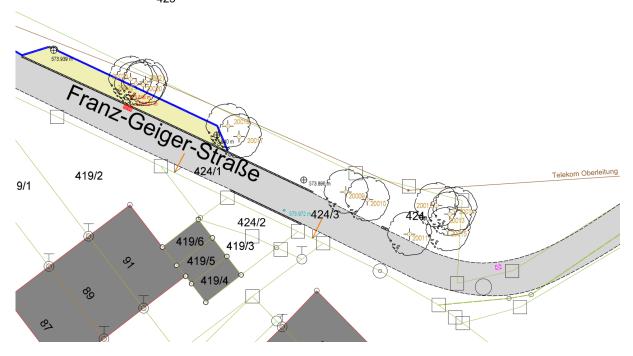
Baumbestand: Franz-Geiger-Straße Richtung Südosten
